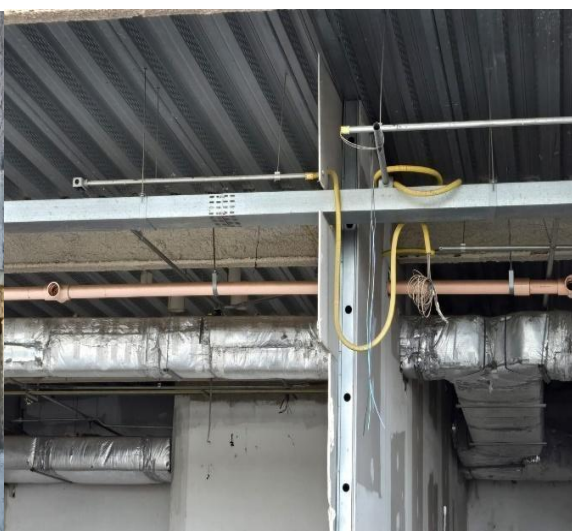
Componentes estruturais HU UFJF. Detalhe para laje steel deck e drywall. Fonte: Os autores (2025).
